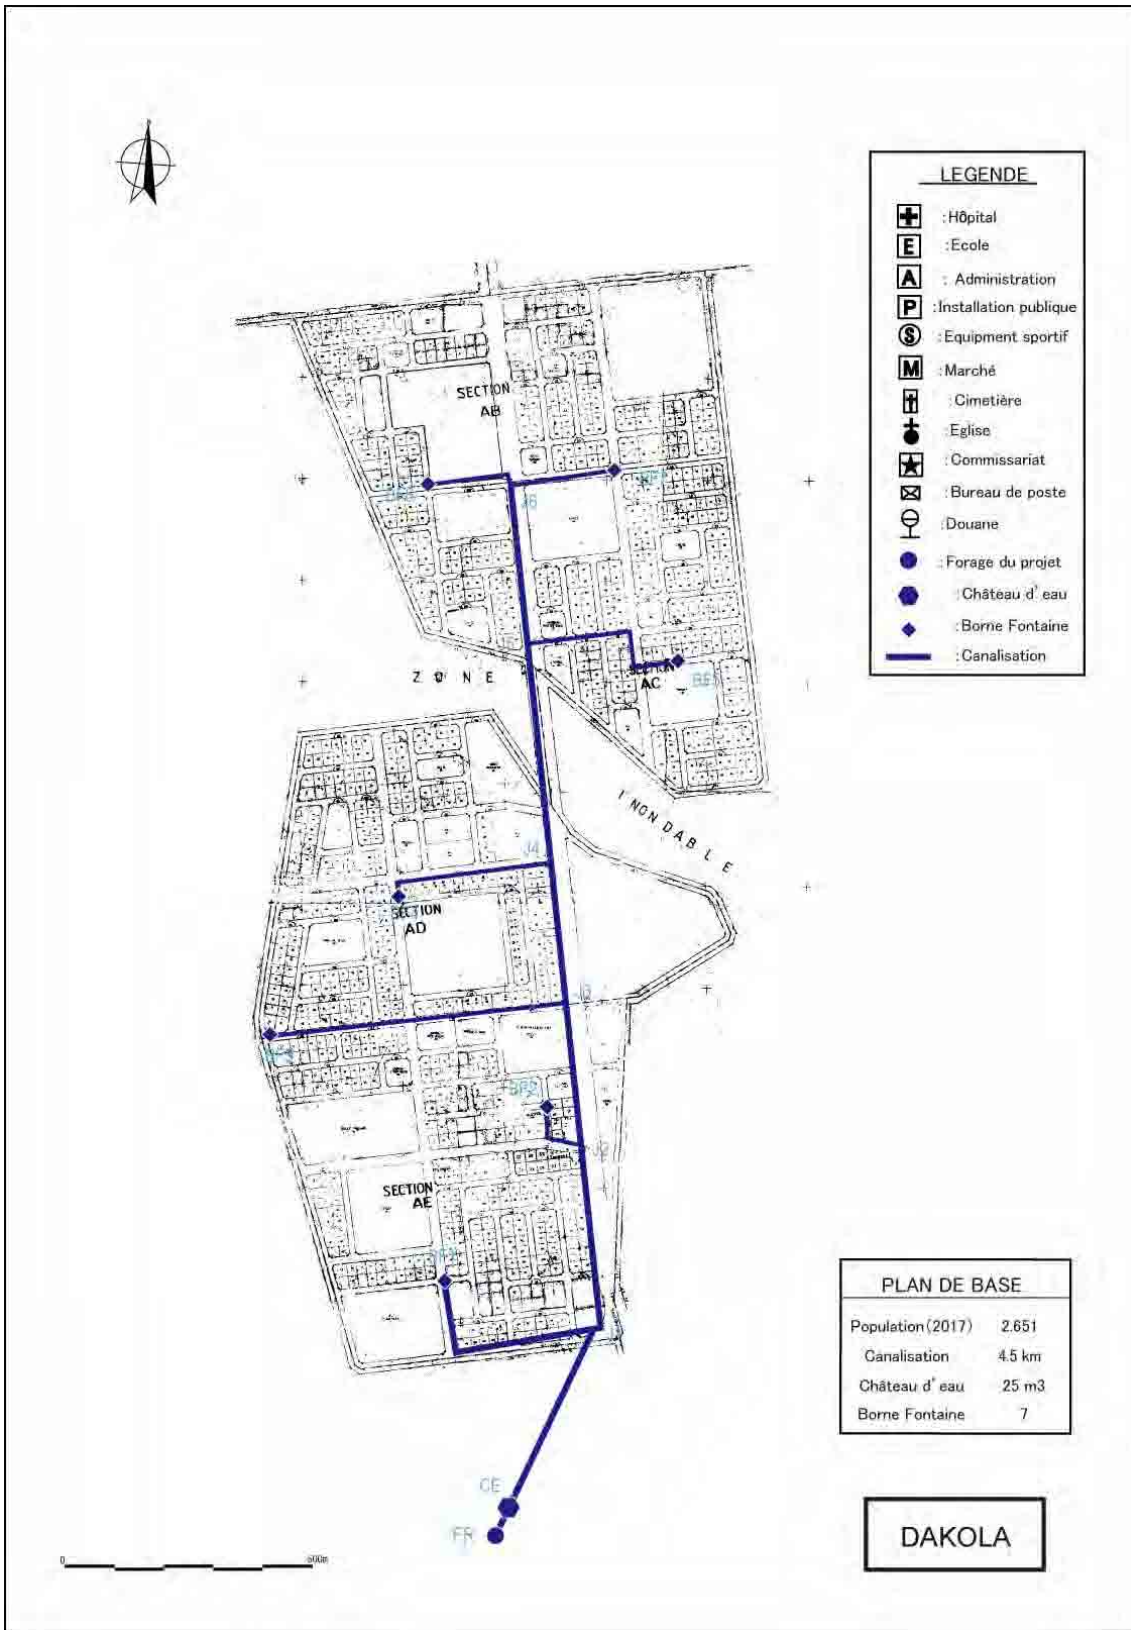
Plan planimétrique de l'AEPS à Dakola
